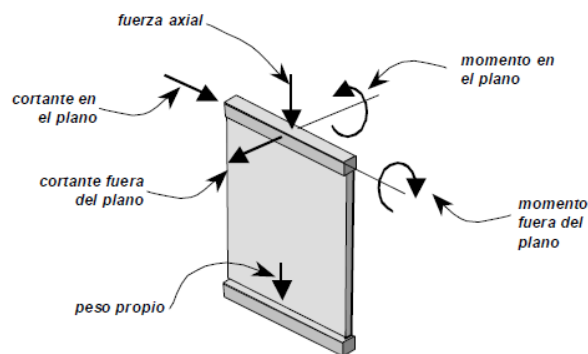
Fuerzas dentro y fuera del plano del muro. Fuente: ACI 318-14 [1].
